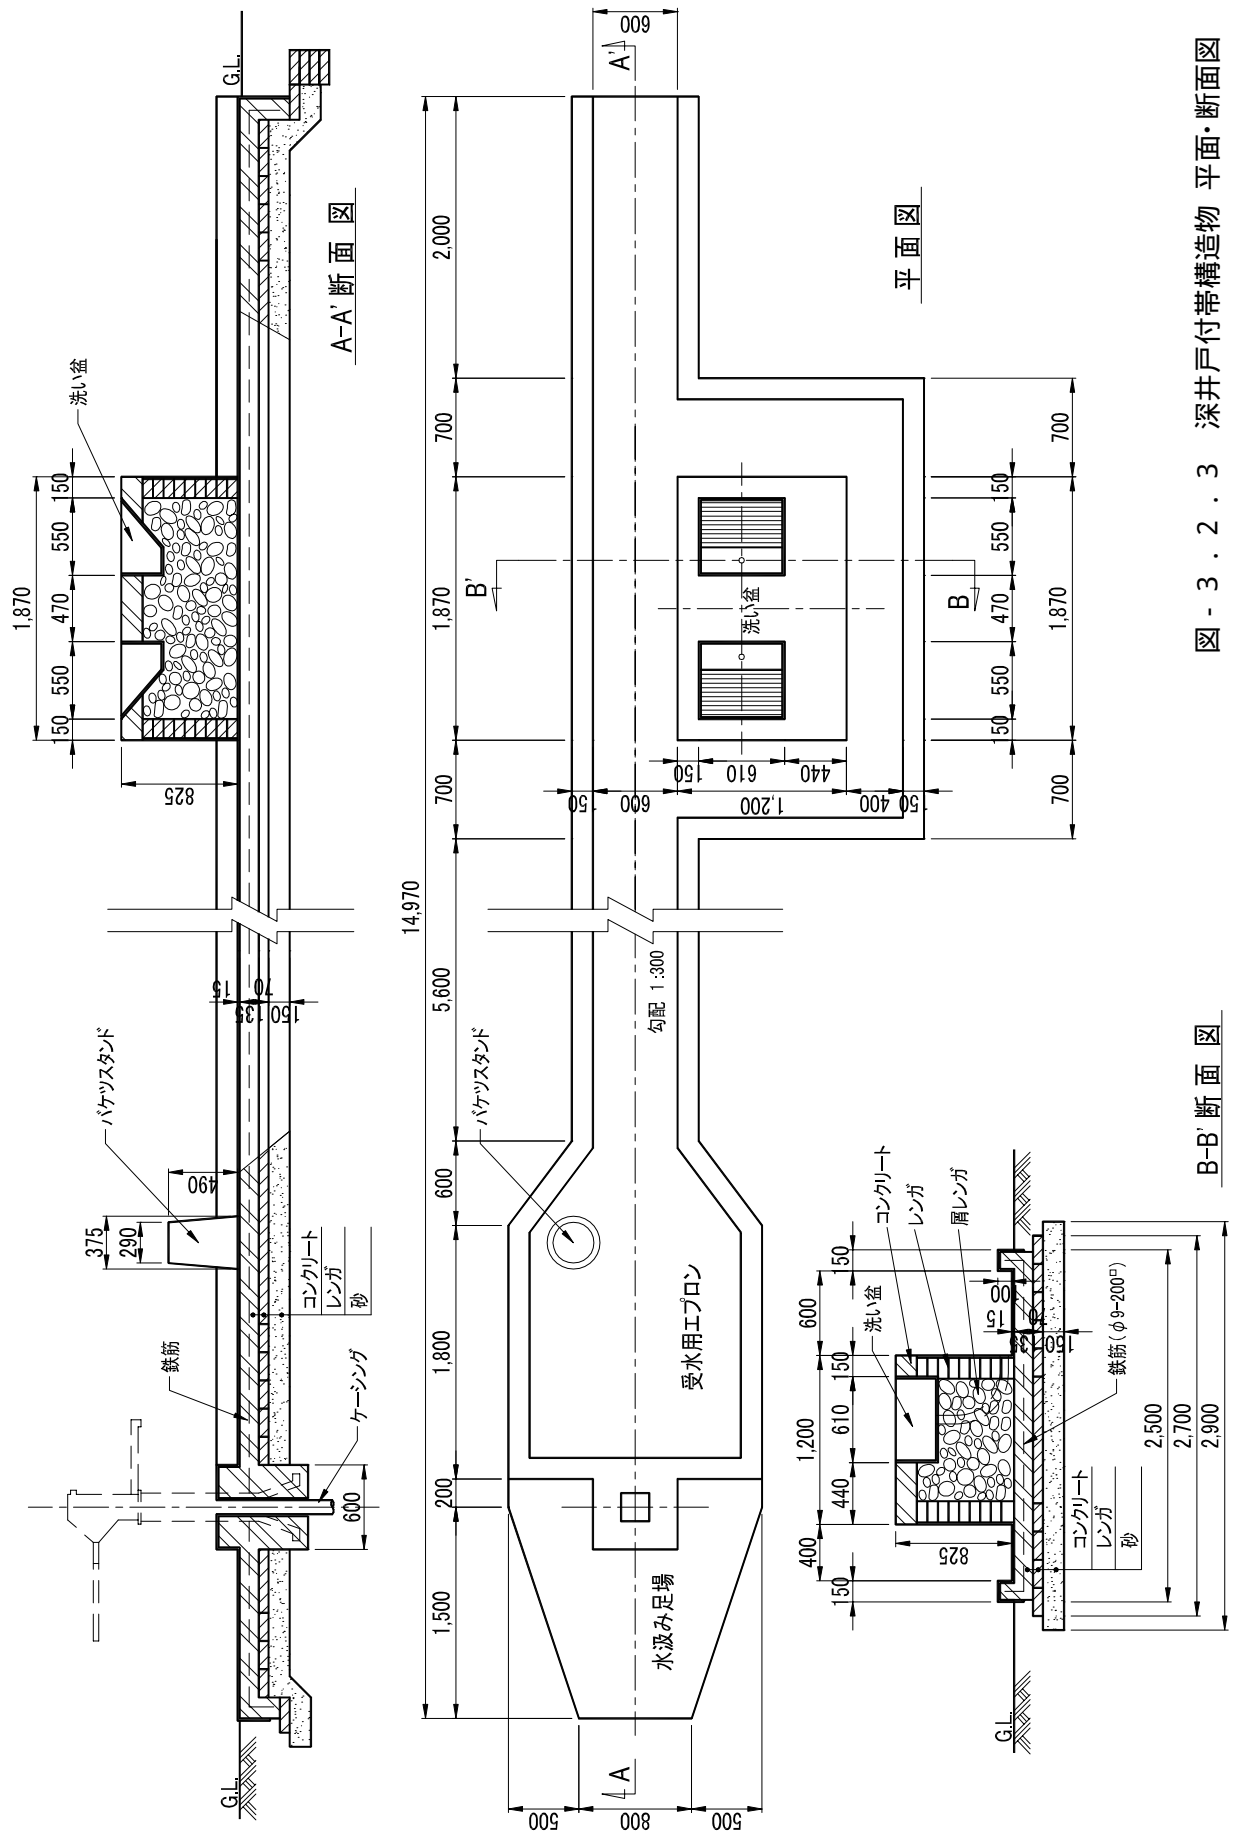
2 . 3 深井戸付帯構造物 平面・断面図
